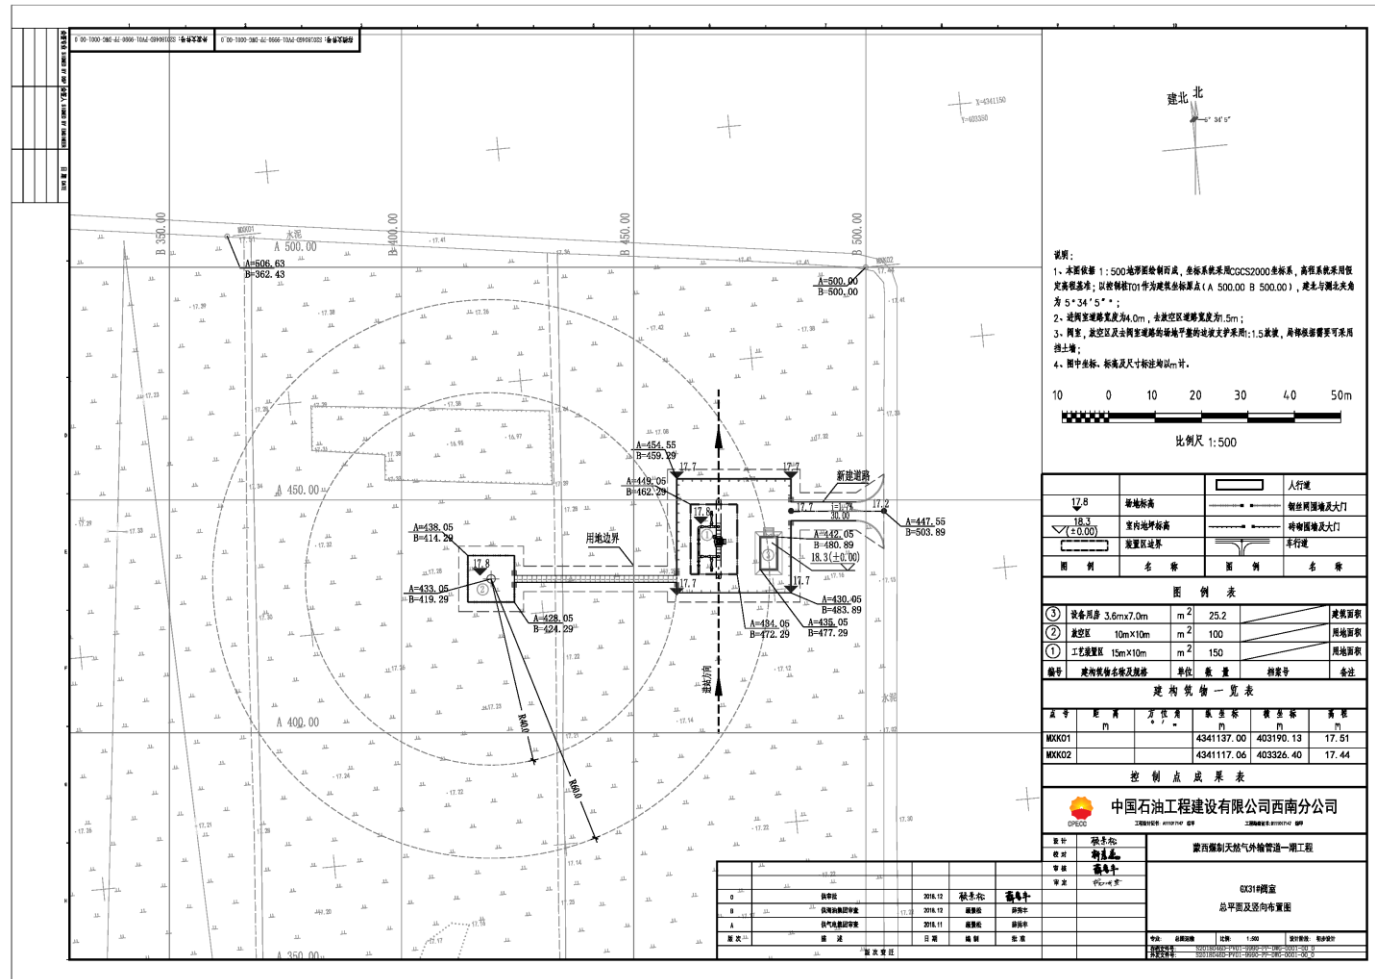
阀室总平面布置图（以 GX31# 阀室为例）
